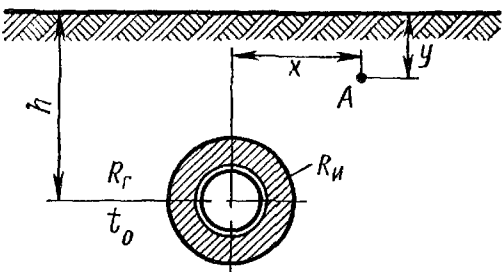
Расчетная схема бесканального однетрубного теплопровода
